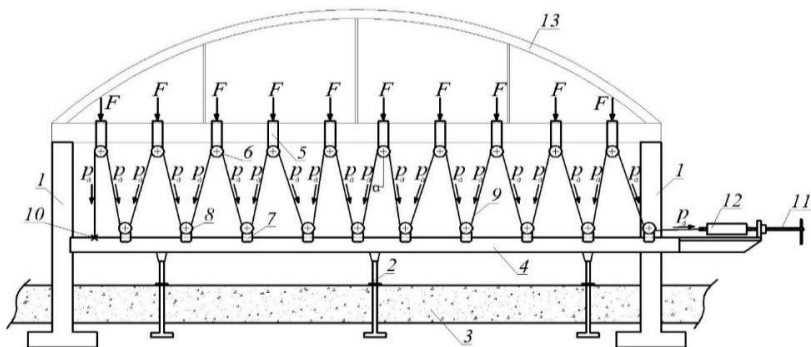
Схема работы стенда для испытания арочной конструкции. 1 – опоры; 2 – анкерные болты; 3 – силовой пол; 4 – вспомогательная балка; 5, 7 – хомуты; 6, 8 – шкивы; 9 – трос; 10 – крепежное кольцо; 11 – винтовое устройство; 12 – динамометр; 13 – арочная конструкция. деревянной балки, которая воспринимает эксплуатационную нагрузку и является одновременно затяжкой в арочной конструкции.
